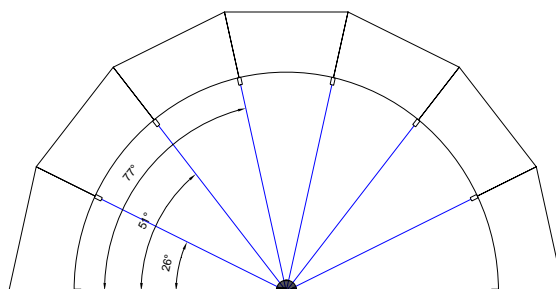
Sistema de cimbra metálico proposto para o vão de 4,0 m.
